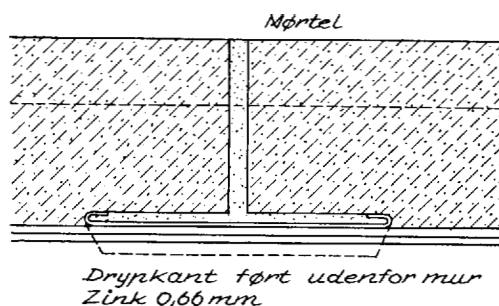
Stødfuge mellem betonafdækningssten med indlagt metalplade.
